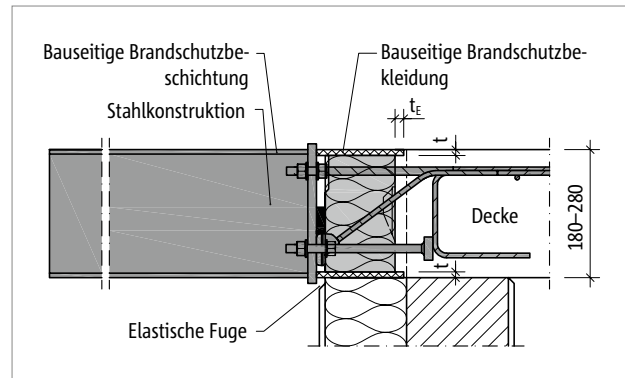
Schöck Isokorb® XT Typ SK: Bauseitige Brandschutzbekleidung für den Isokorb®, brandschutzbeschichtete Stahlkonstruktion; Schnitt
